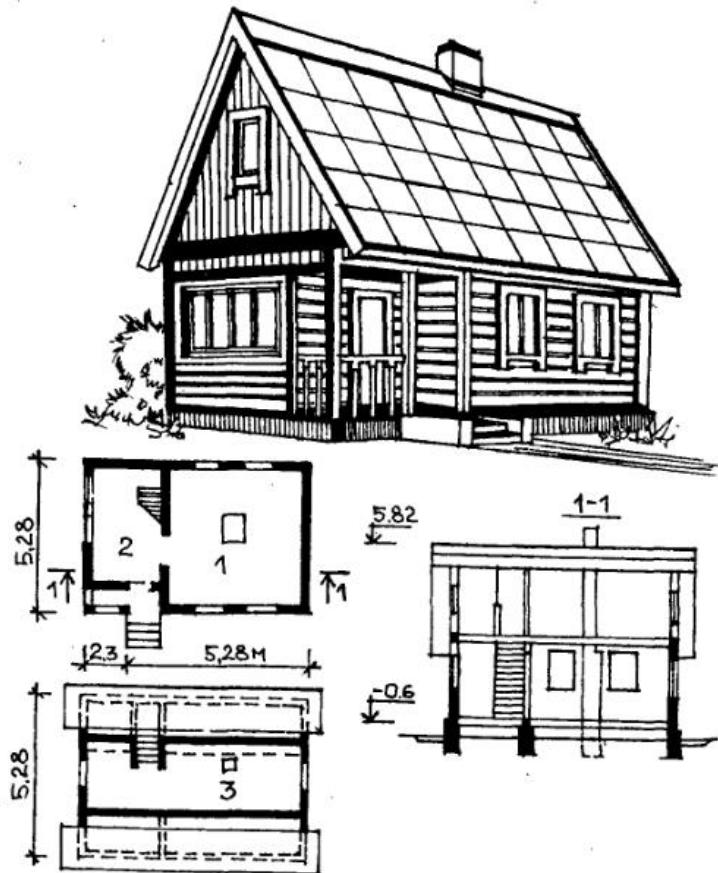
Садовый домик с мансардой со стенами из бруса. Состав помещений: 1 — комната — 25,00 м<sup>2</sup>, 2 — веранда — 9,55 м<sup>2</sup>, 3 — мансарда — 14,94 м<sup>2</sup>. Строительные конструк-
